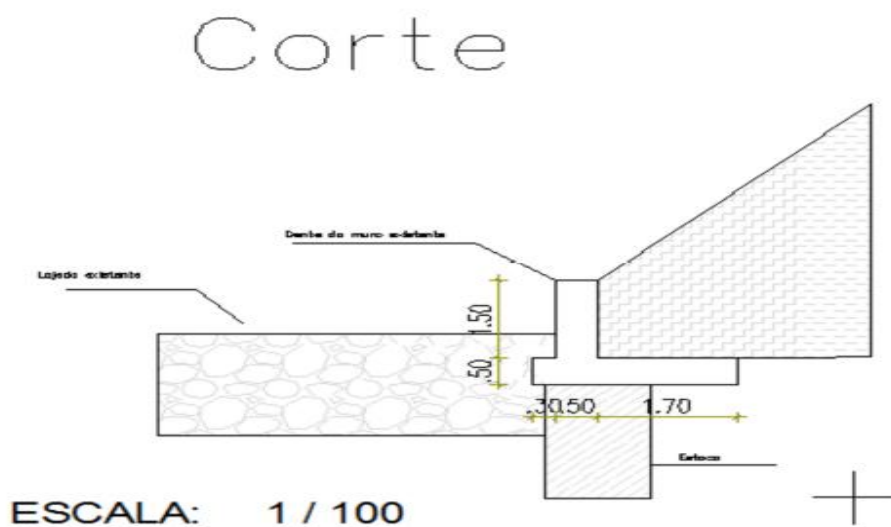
Corte á escala de 1/100 muro, fundação e enrocamento do leito. [11]
